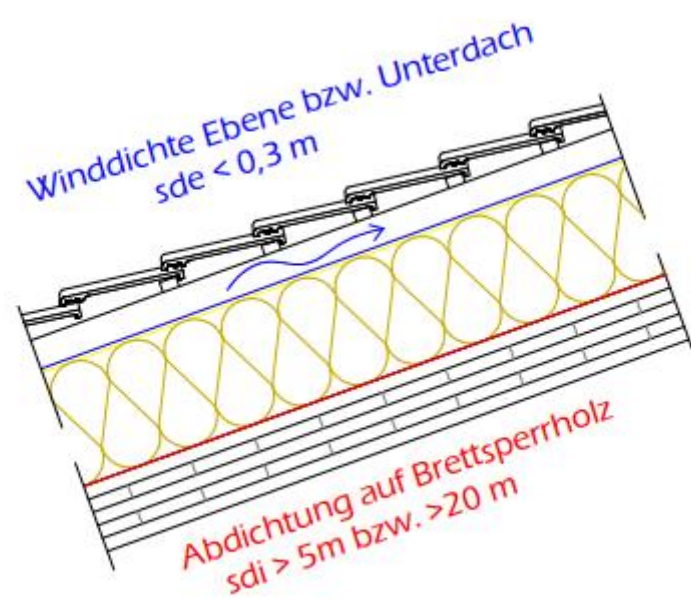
Schrägdach über massiver Dachkonstruktion mit hinterlüfteter Dachkonstruktion
